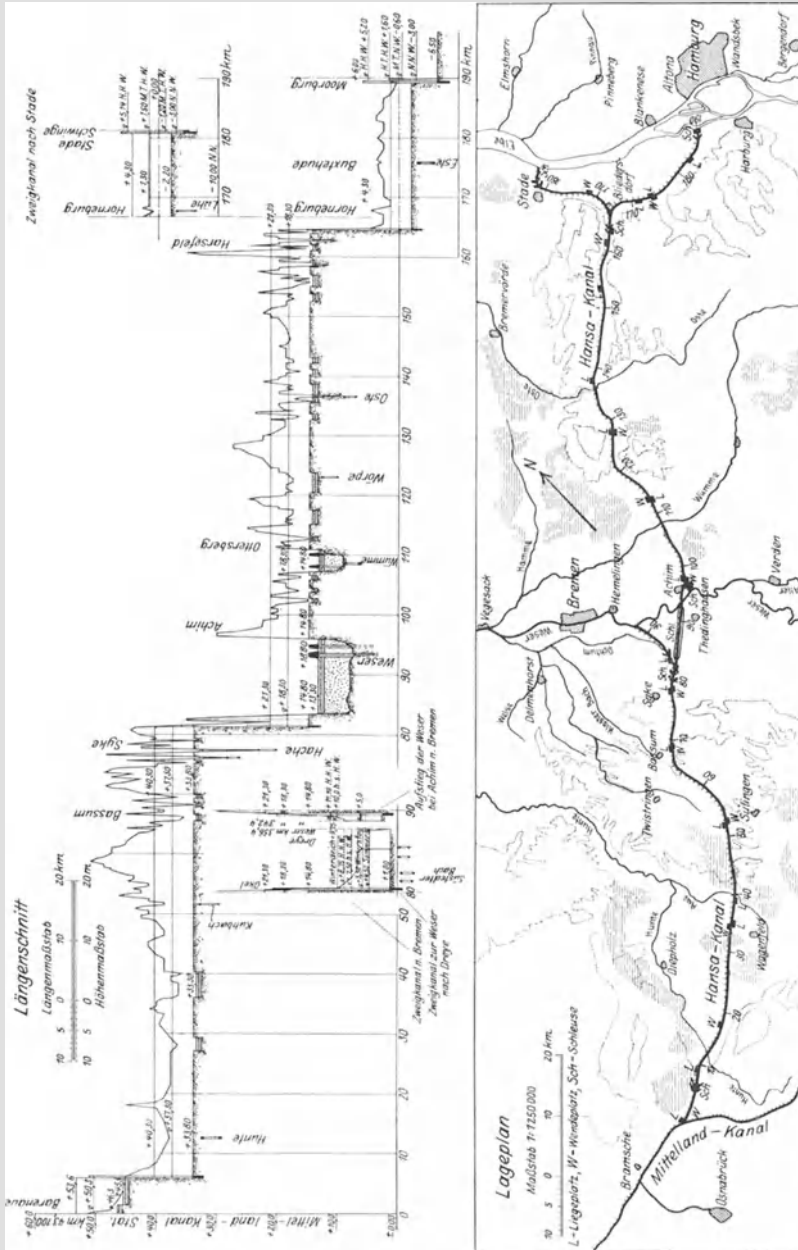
a. u. b. Hansa-Kanal. Lageplan und Längenschnitt. Längenmaßstab 1 : 1 250 000. Höhenmaßstab 1 : 1250.
